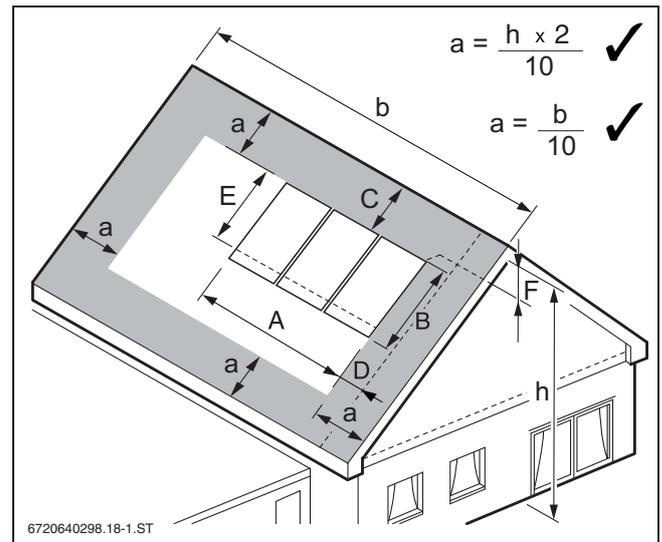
Fabbisogno di spazio per il montaggio sopra tetto di collettori piani (spiegazione nel testo)
